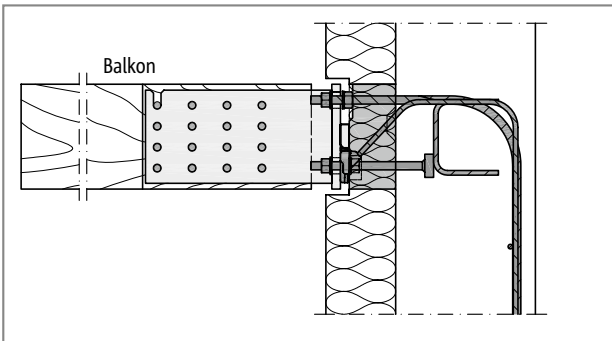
Schöck Isokorb® T Typ SKP-WU mit Stahlschwert: Sonderkonstruktion; erforderlich bei Anschluss an eine Stahlbetonwand
